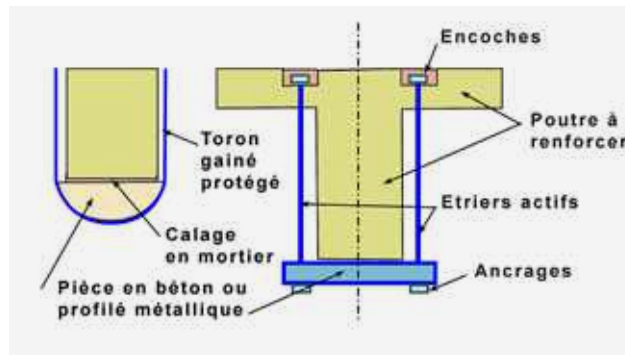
principes de renforcement d'une poutre à l'effort tranchant par étriers actifs extérieurs
